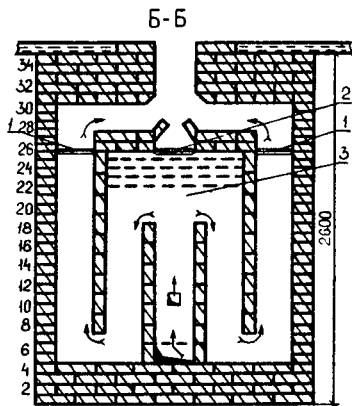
Печь отопительно-варочная № 9, разрез по линии Б — Б: 1 — задвижки зимние; 2 — задвижка летняя; 3 — перевалы
